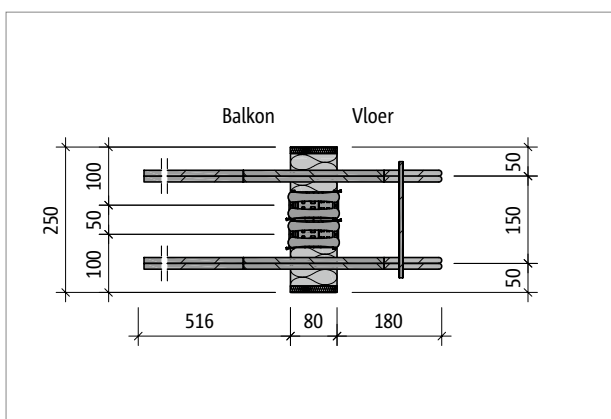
Schöck Isokorf® T type Q-E-VV5: Bovenaanzicht; brandwerende platen aan de zijkant
